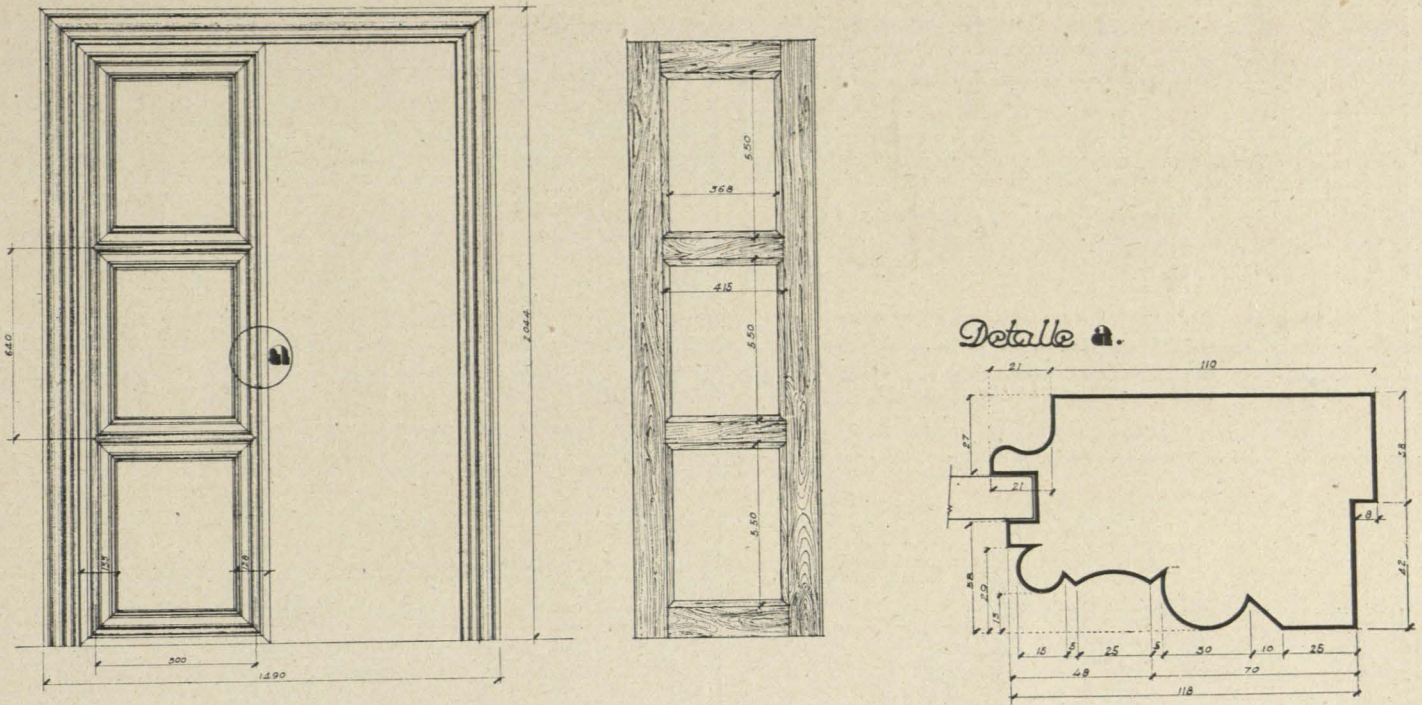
Detalles de la puerta de la Sala Capitular.
